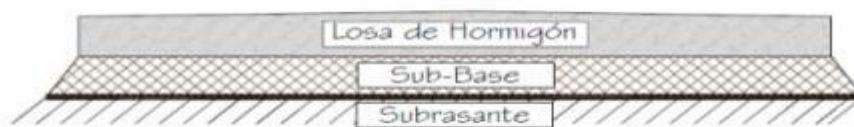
Sección del Pavimento Hidráulicos: Fuente: (Bermudez, 2006)
